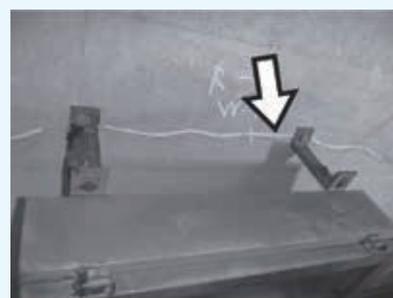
アンカー周辺の覆工コンクリートのひび割れ
